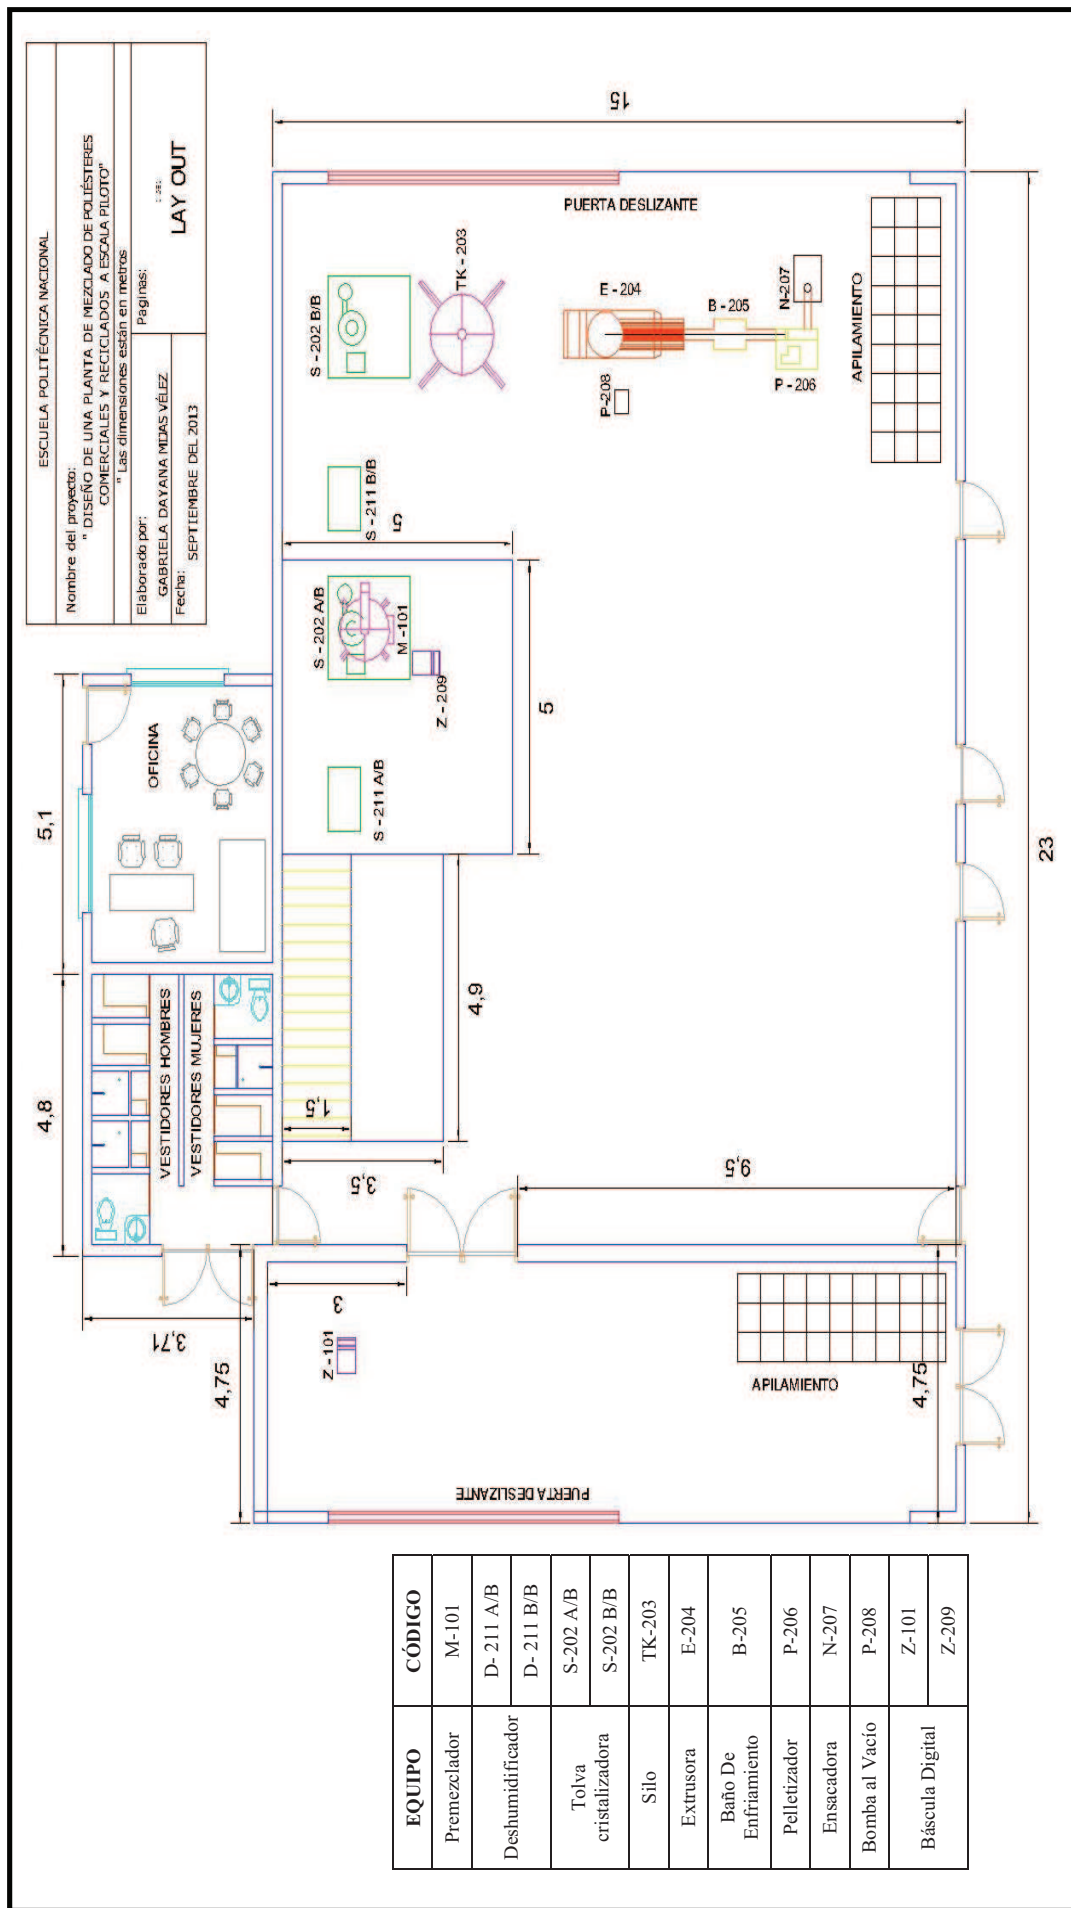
Plano de distribución (Lay out) de la planta piloto de mezclado de poliésteres comerciales y reciclados
